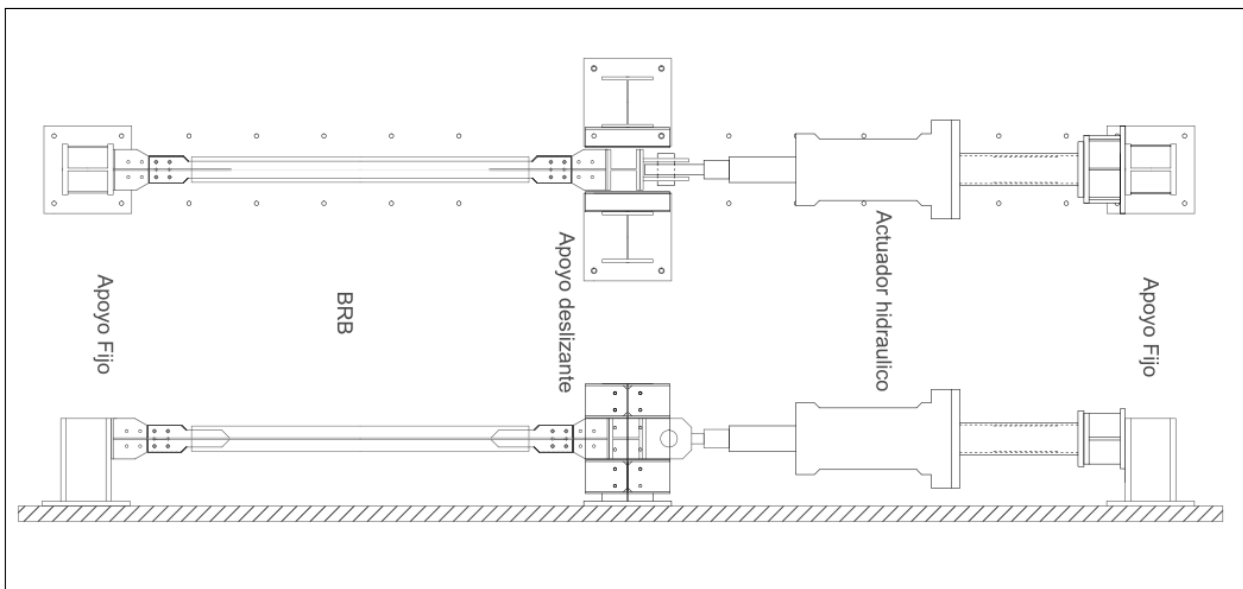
Vista en planta y elevación del sistema de ensayo (Espinoza 2016).
